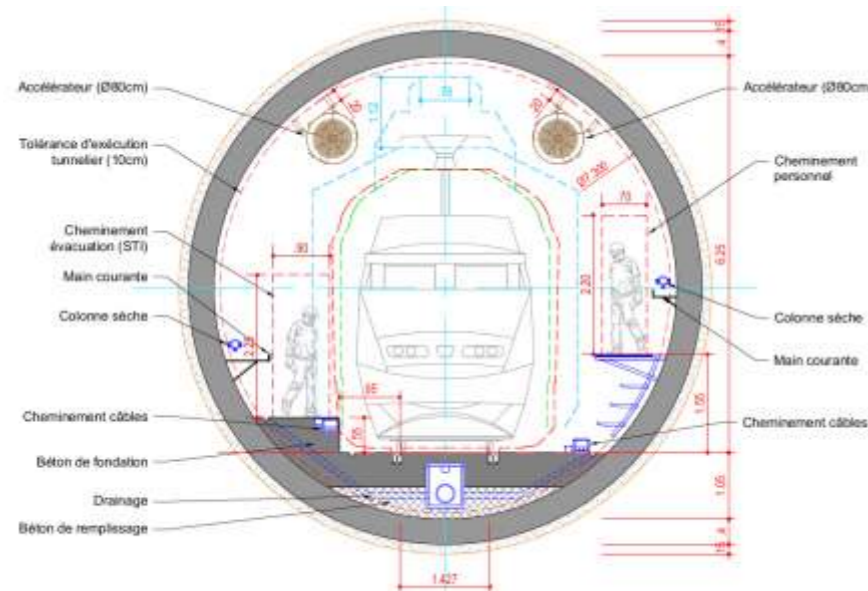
Coupe tunnel - alignement droit (EGIS, 2021)
